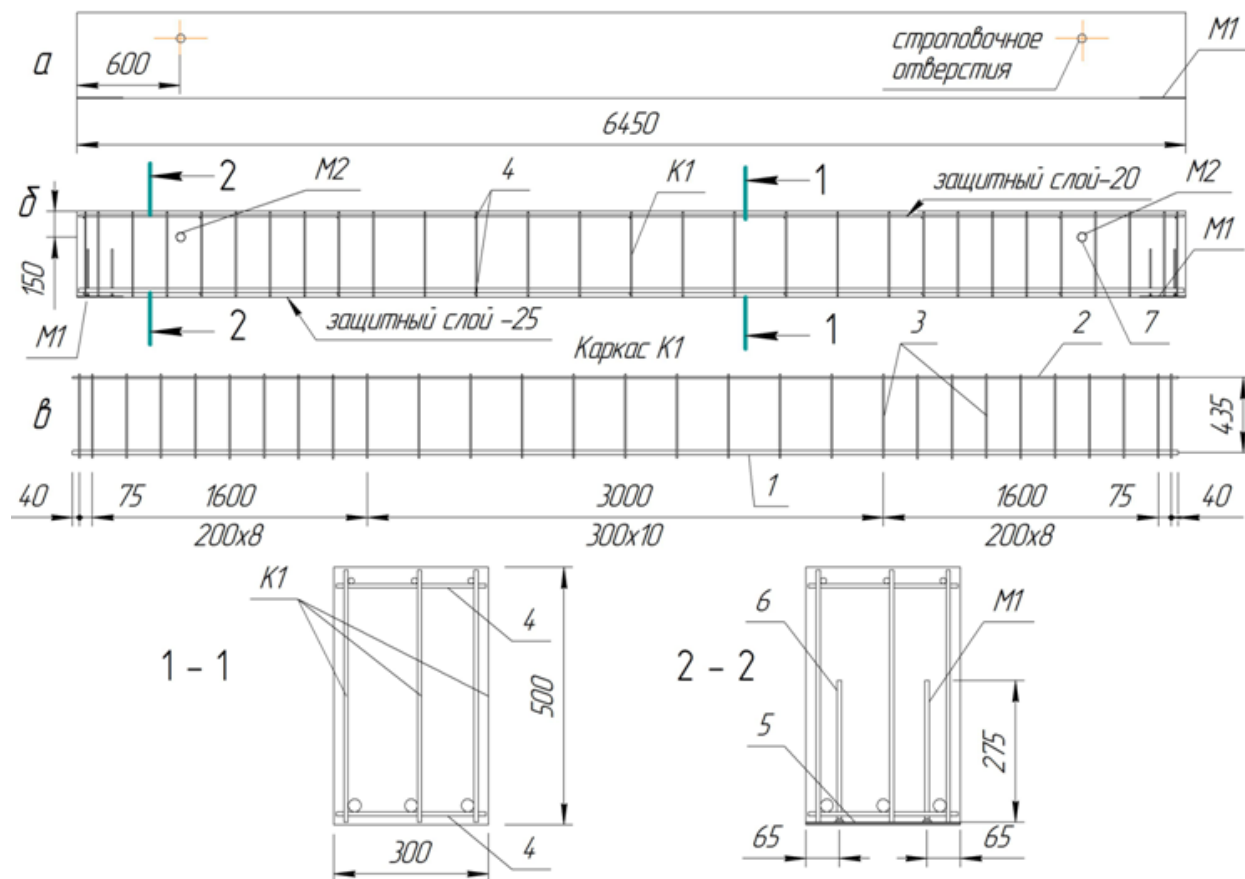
Конструктивное решение ригеля: а – общий вид; б - схема армирования; в – каркас К-1
